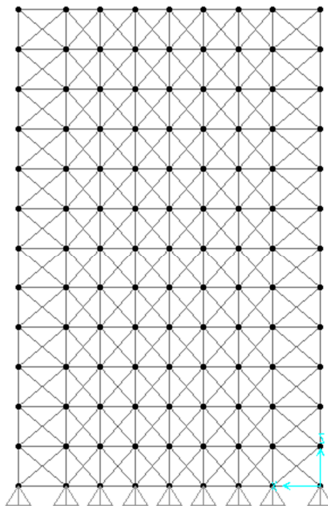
Configuração dos Planos de Contraventamento Vertical Com Elementos de Contraventamento Pequenos
